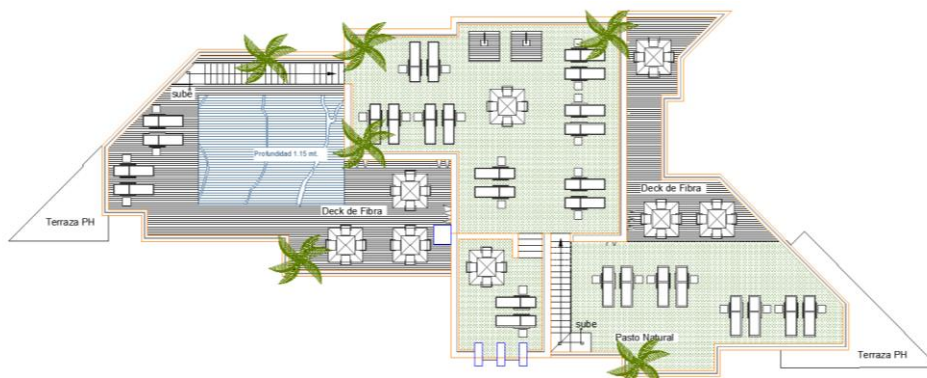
Figura IV-VII Planta arquitectónica Nivel Roof- Garden
